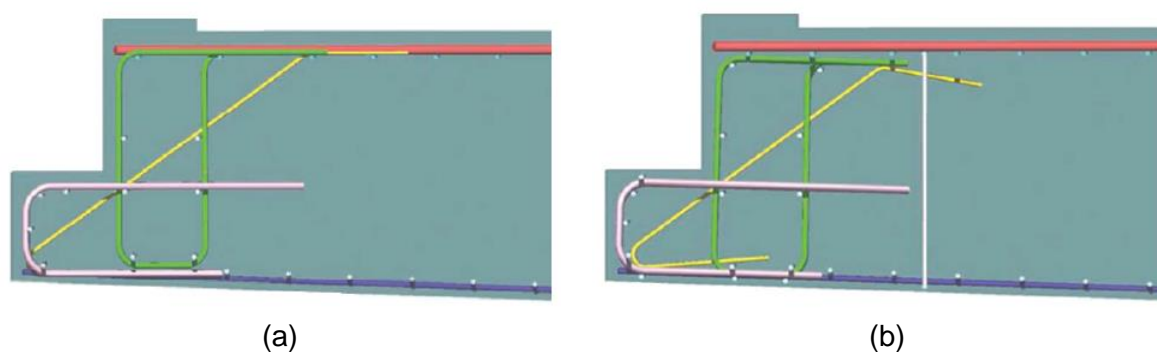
Detalhamento das armaduras do balanço e da ligação em dente.
